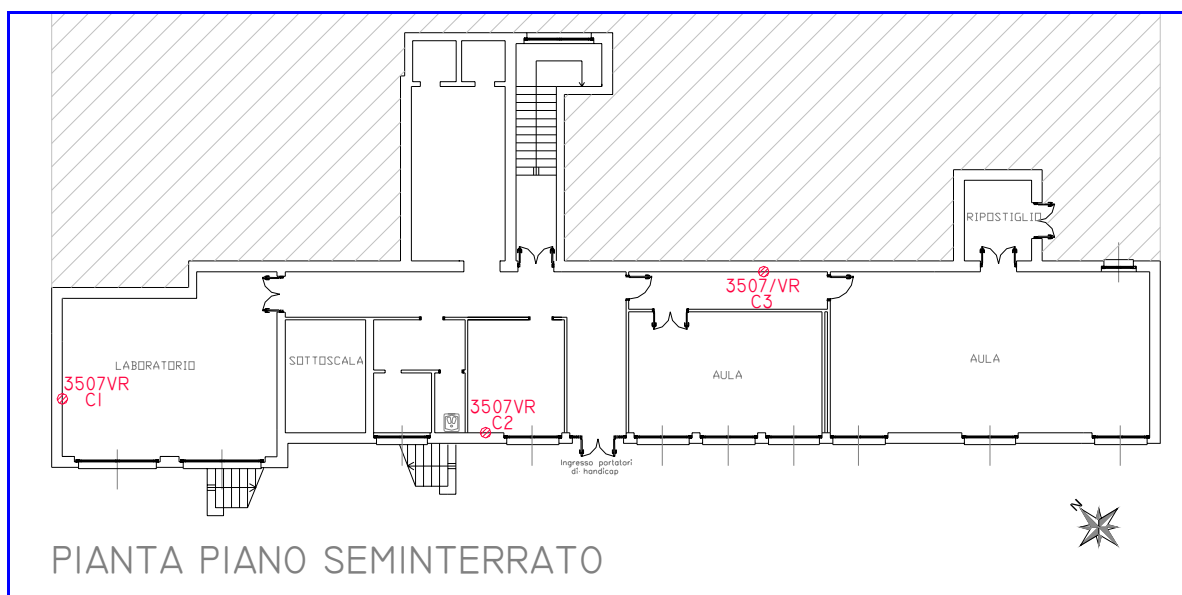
Planimetria piano seminterrato con ubicazione prelievi mediante carotaggi
